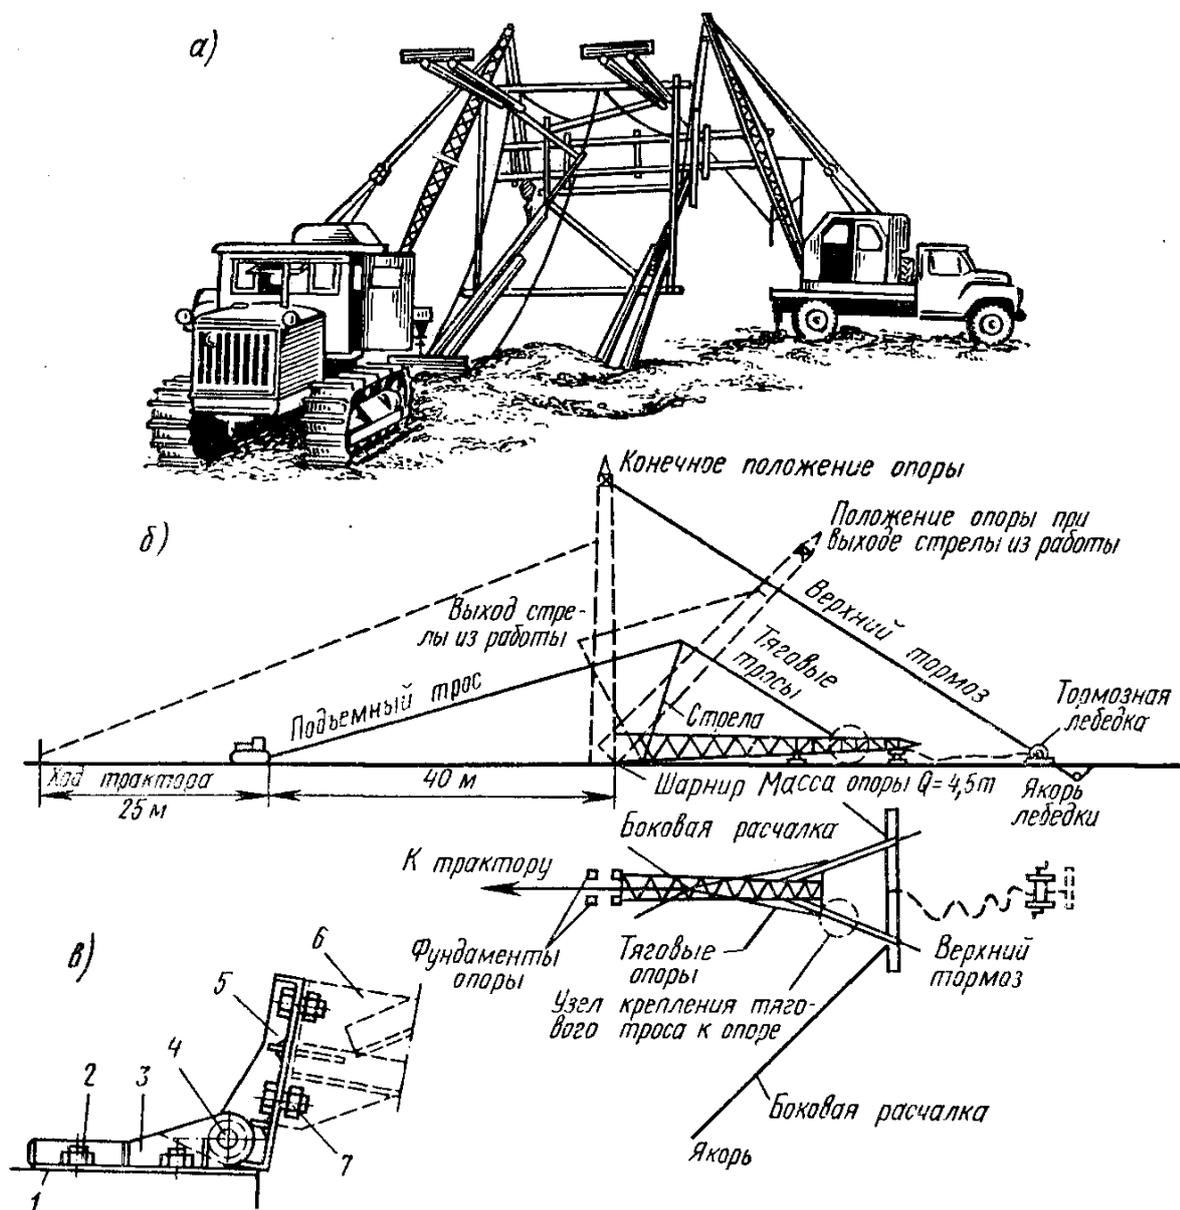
Варианты способов установки опор: а - установка сложной деревянной опоры с помощью крана и трактора; б - установка одностоечной опоры с помощью падающей стрелы и трактора; в - шарнир для установки свободно стоящей металлической опоры; 1 - подножник; 2 - анкерный болт; 3 и 5 - нижняя и верхняя пластины шарнира; 4 - ось шарнира; 6 - плита опоры; 7 - болты крепления опоры к шарниру
